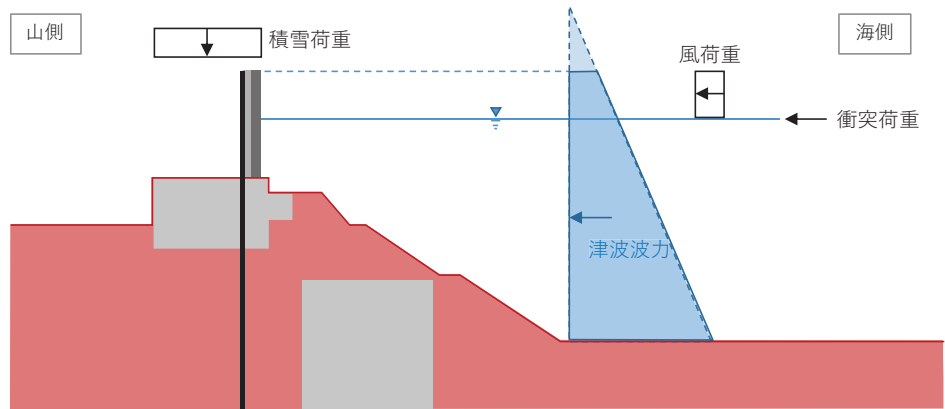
津波荷重+漂流物荷重による構造物に作用する水平力のイメージ図
